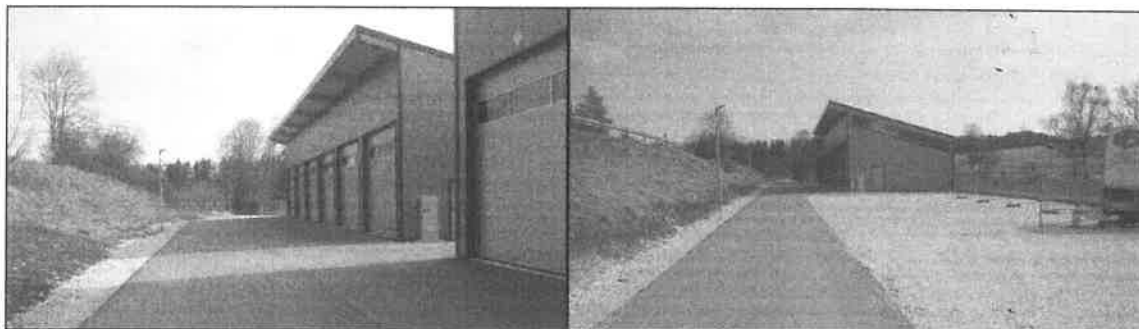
Garagengebäude und asphaltierte Zufahrt.
